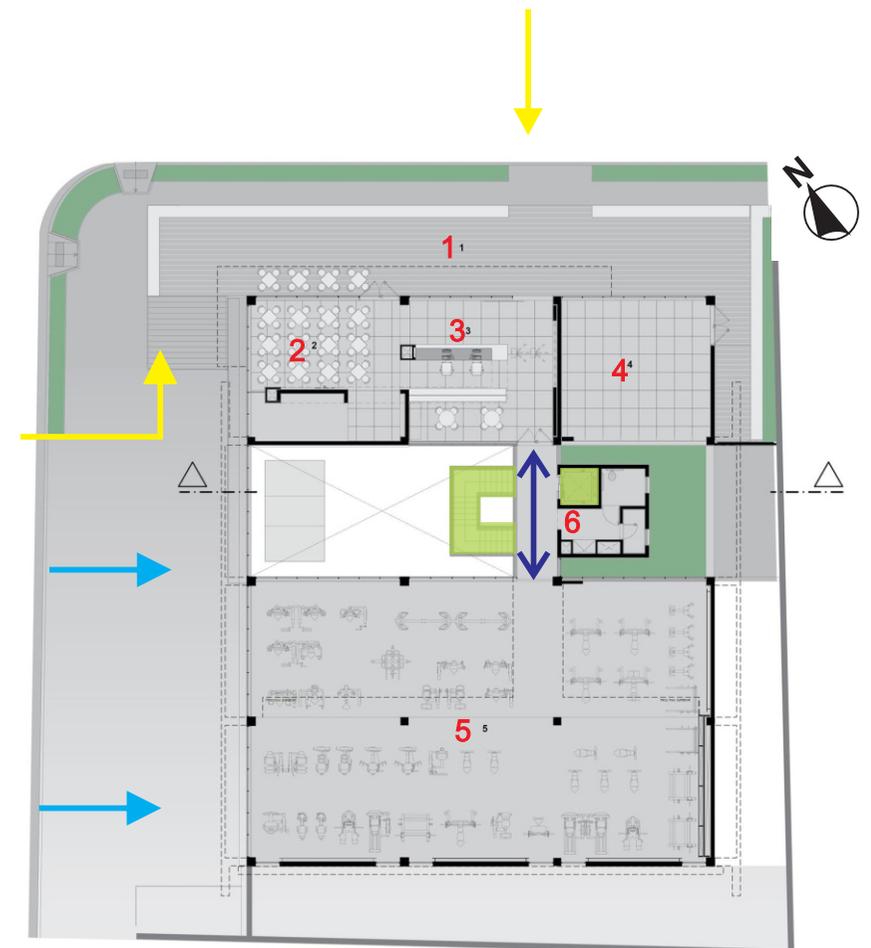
Planta baixa Térreo. Fonte: Site Archdaily
